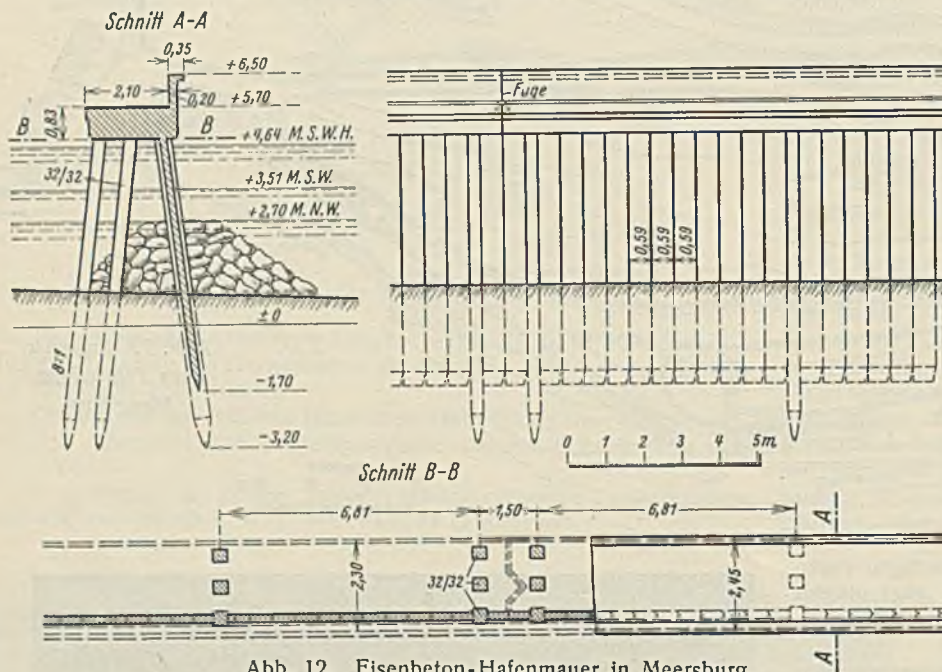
Eisenbeton-Hafenmauer in Meersburg.
